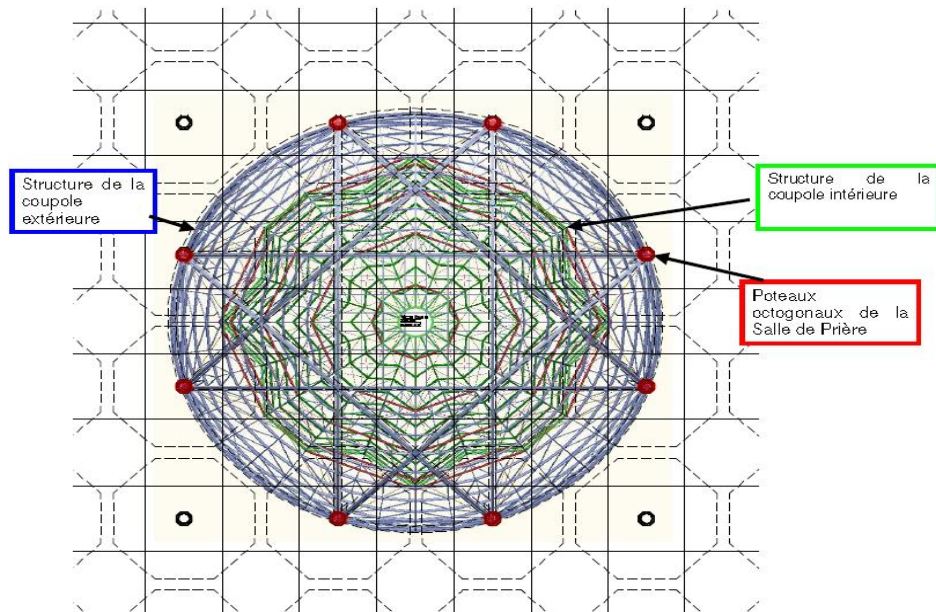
Vue en plan de la structure porteuse de la coupole avec les points d'appui sur les poteaux octogonaux.
